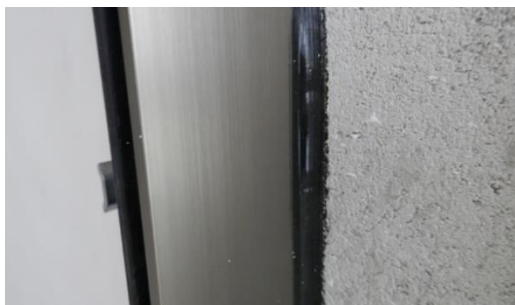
Vedação entre o caixilho e a ombreira antes da aplicação do isolamento exterior
